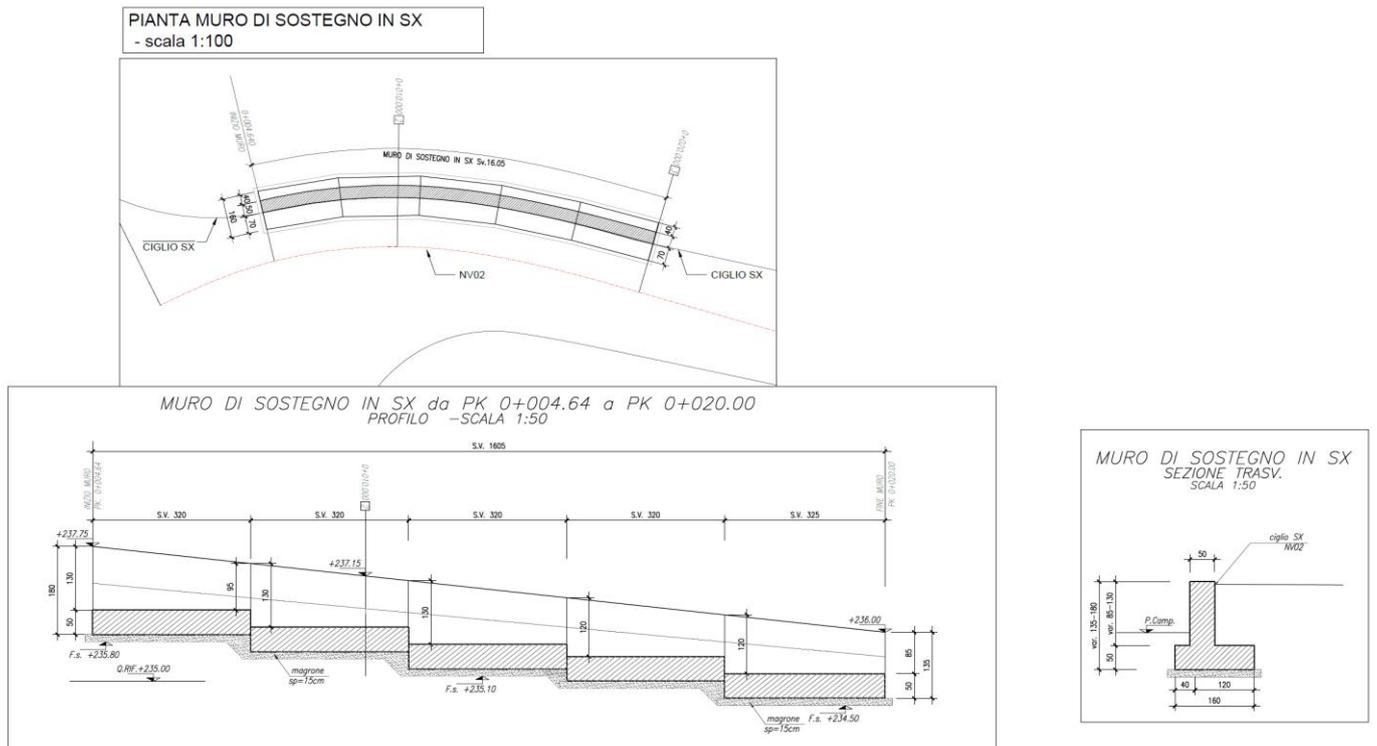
NV02 – Pianta, profilo e carpenteria muro tra la pk 0+004,64 e la pk 0+020
